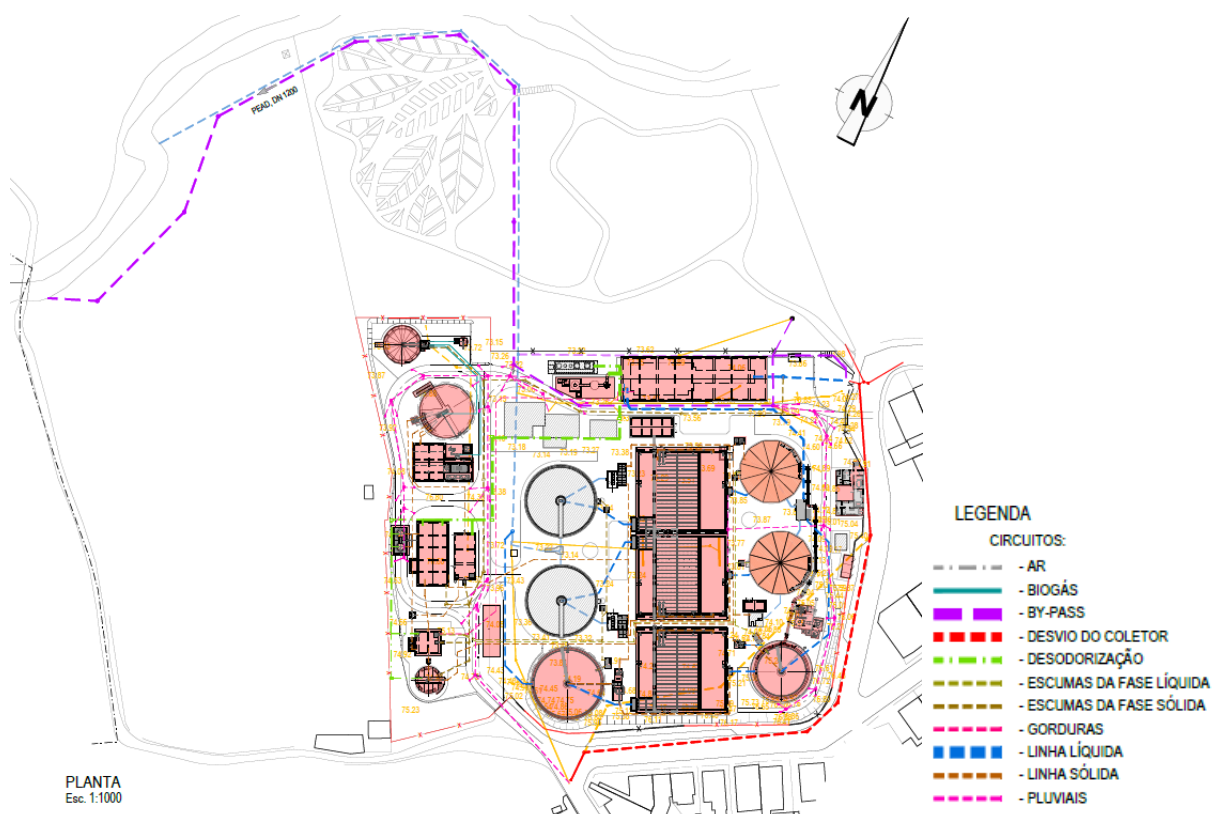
Planta da ETAR de Ermesinde e Alfena.
